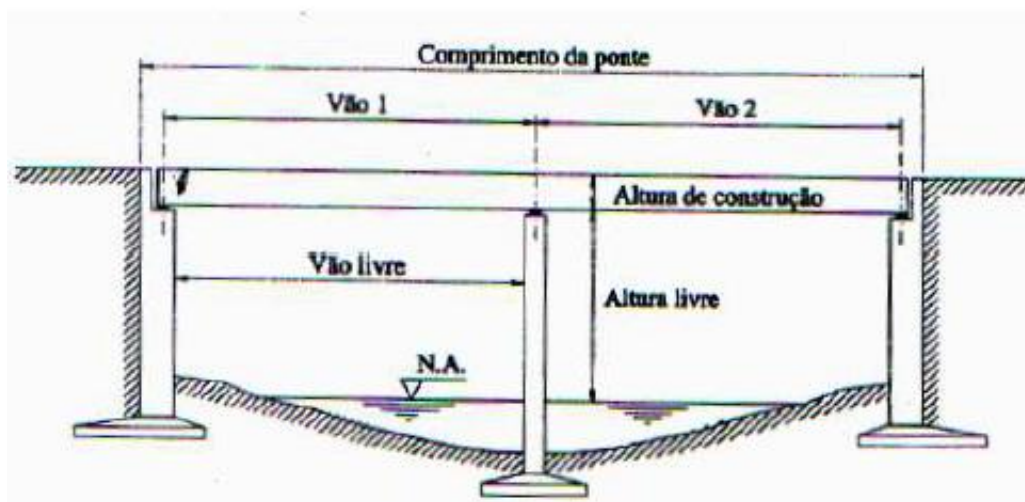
Elementos constituintes de uma seção longitudinal de ponte
